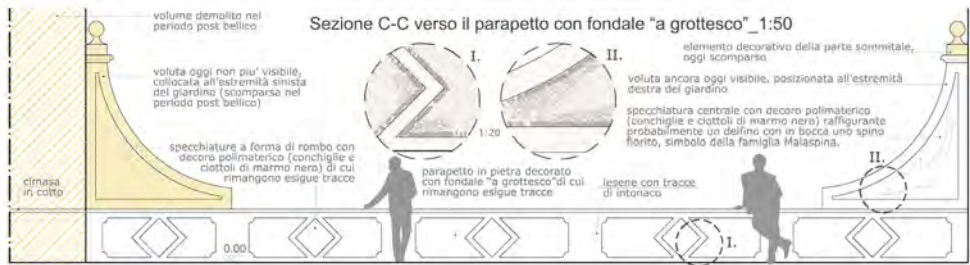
Sezione del giardino verso il parapetto con fondale decorato “a grottesco”. Estratto dalle tavole di Tesi (tav. 7)
